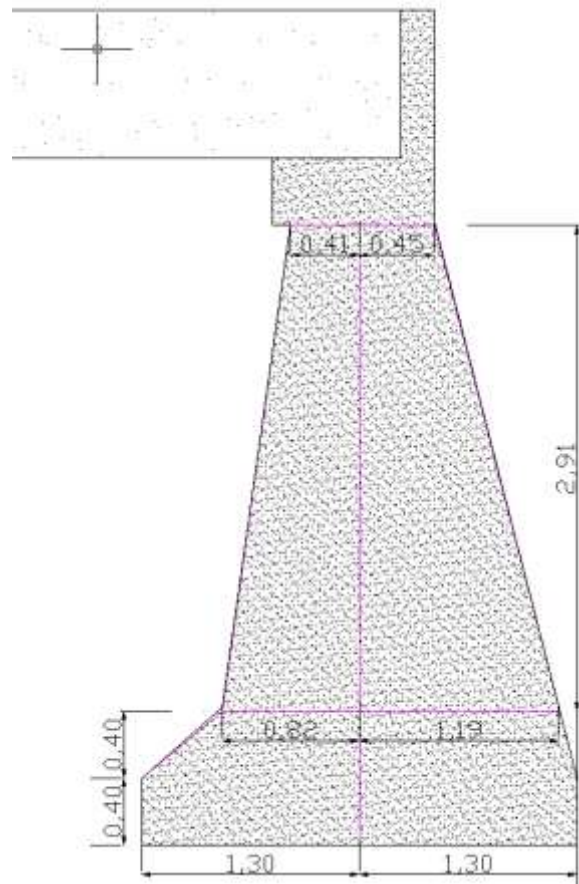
Detalle de columnas laterales del Puente Vehicular “El Playón”
